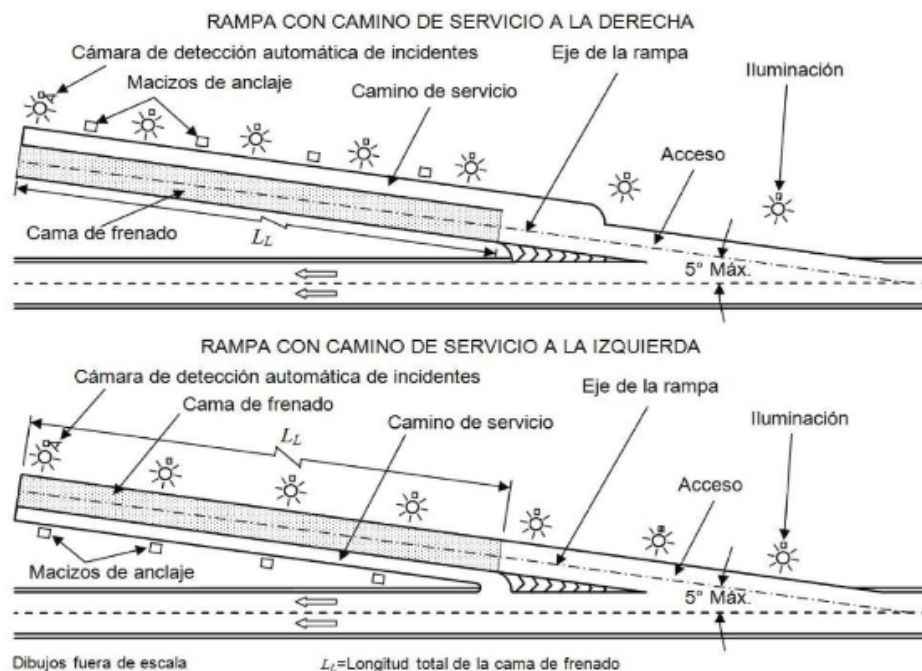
Rampa de emergencia para frenado. Esquema de disposición en planta
